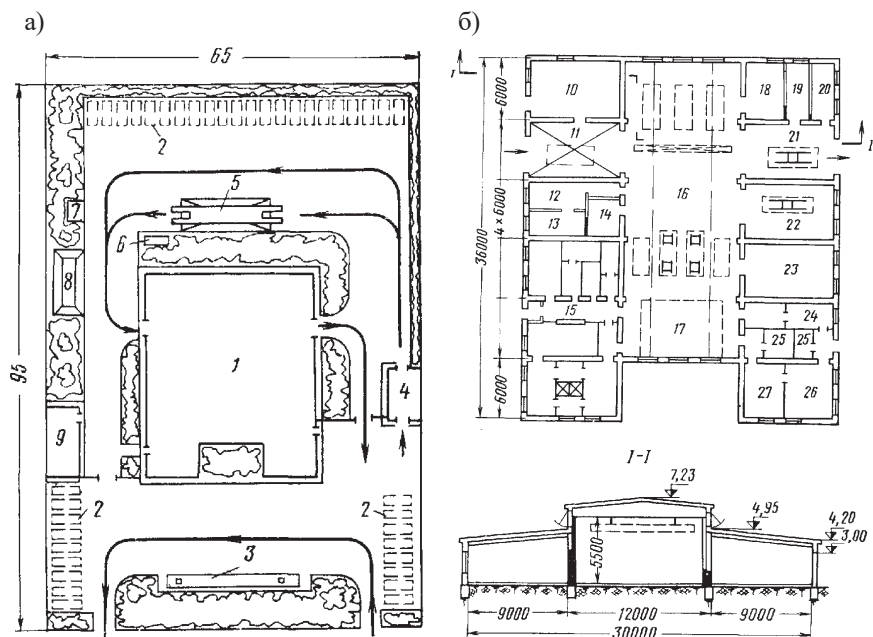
Планировка СТО на 10 рабочих постов: а - генеральный план: 1 – производственный корпус; 2 – стоянка автомобилей; 3 – заправочный пункт; 4 – пост приемки и сдачи; 5 – эстакада для мойки автомобилей; 6 – производственный корпус; 6 – грязеотстойник; 7 – склад золы и шлака; 8 – склад угля; 9 – хозяйственный склад; 10 – встроенная котельная; 11 – пост мойки автомобилей; 12 – электрокарбюраторное отделение; 13 – аккумуляторное отделение; 14 – склад смазочных материалов; 15 – бытовые помещения; 16 – посты ТО и ТР; 17 – агрегатно-механическое отделение; 18 – жестяницкое отделение; 19 – обоевое отделение; 20 – шиномонтажное отделение; 21 – пост контроля; 22 – малярное отделение; 23 – склад запчастей; 24 – буфет; 25 – санузлы; 26 – помещение для клиентов; 27 – контора.
